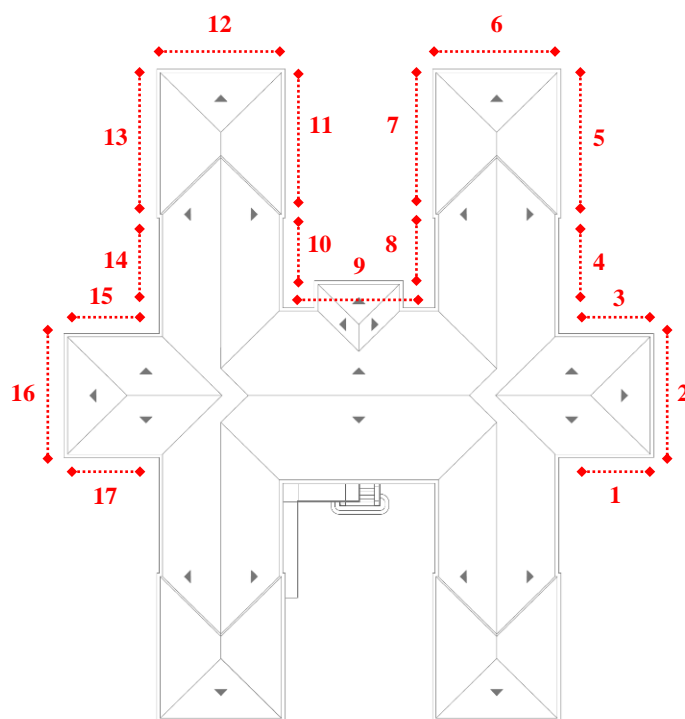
Planta da cobertura e indicação das vistas da envolvente exterior
